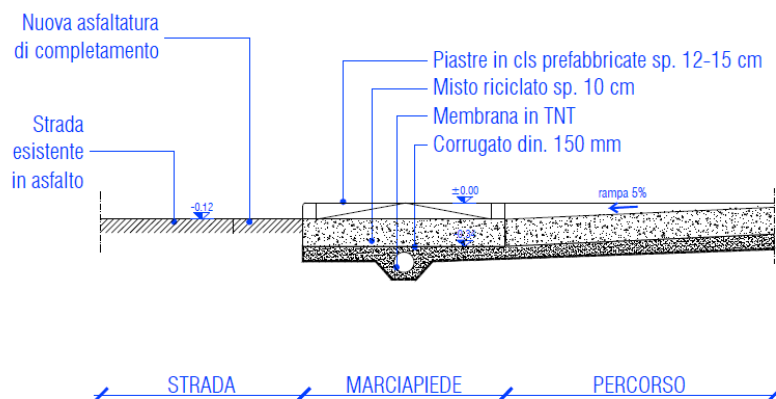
Sezione tipo (camminamento in elementi prefabbricati in cls)
